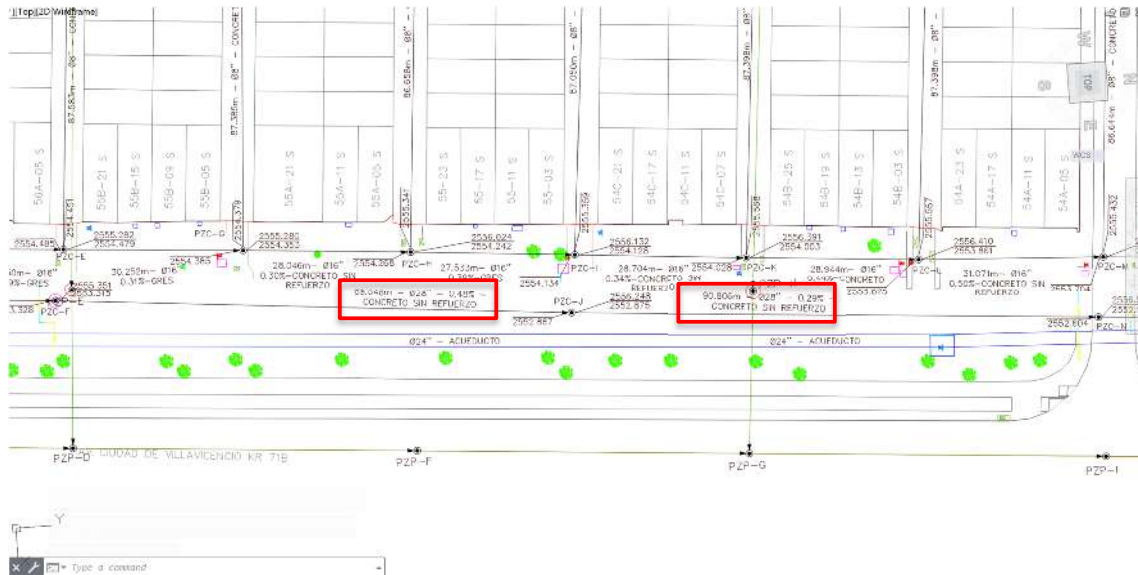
Cuantificación de longitud alcantarillado sanitario 28".
